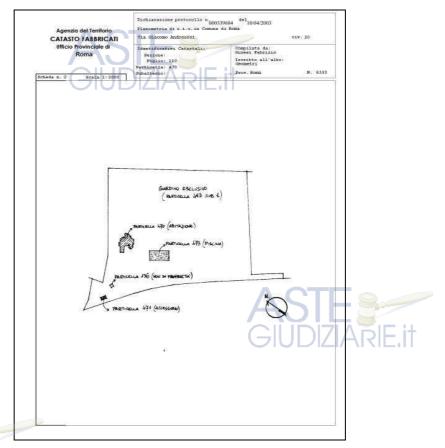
Elaborato planimetrico Fgl 110 p.lla 470, 471, 473 e 493 sub 1
